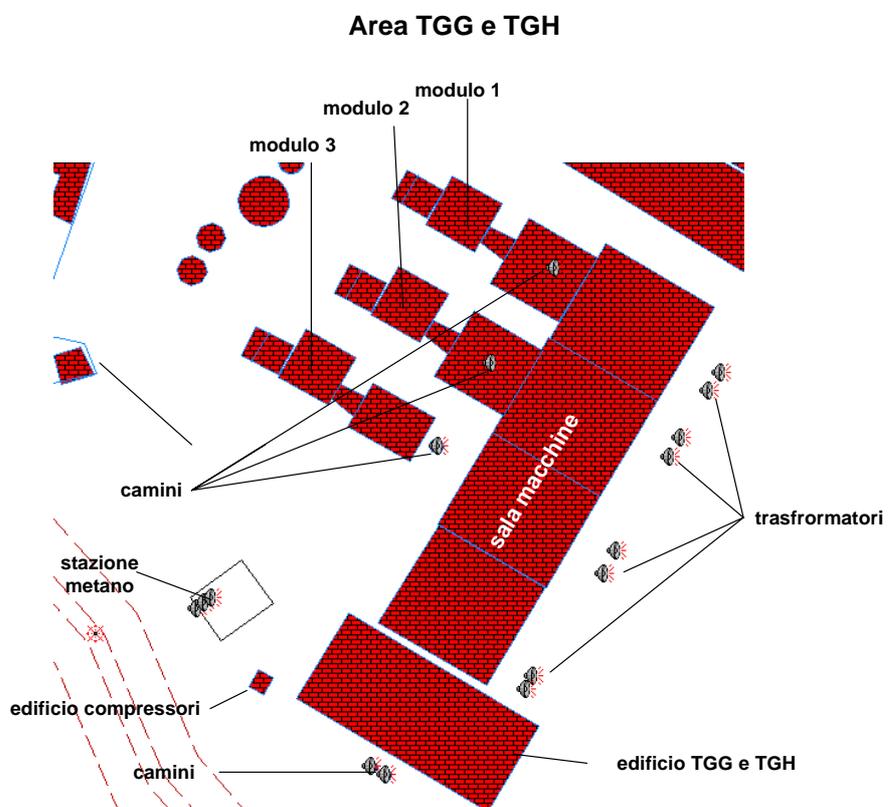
/4 - Layout dell'impianto nella situazione futura (3 cc + 2 tg)
